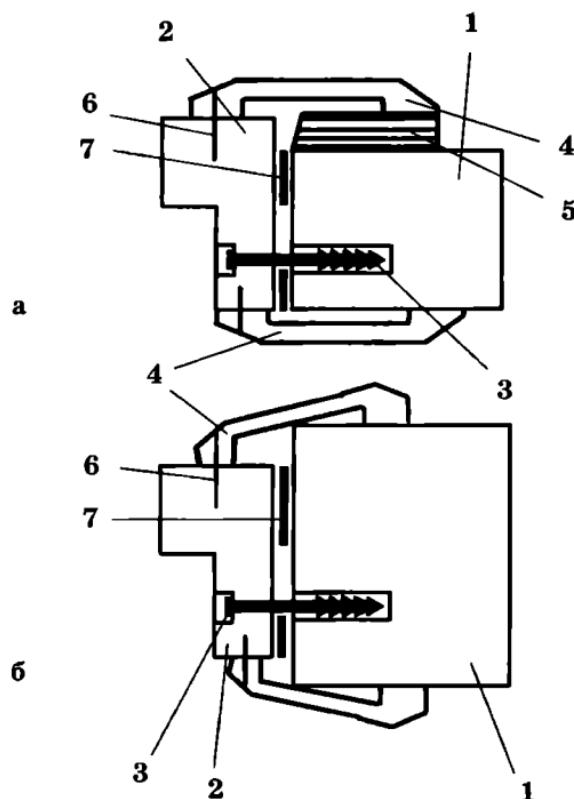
Установка дверной коробки, совпадающей по толщине с дверным проемом: 1 — толщина дверного проема; 2 — дверная коробка; 3 — наличники; 4 — уплотнитель; 5 — дверное полотно; 6 — дверные петли
